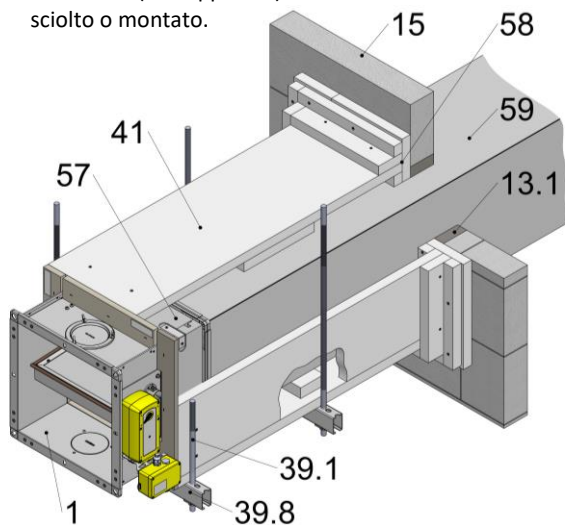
montaggio con controltaio tipo ERA2 distanziato dalla parete massiccia
